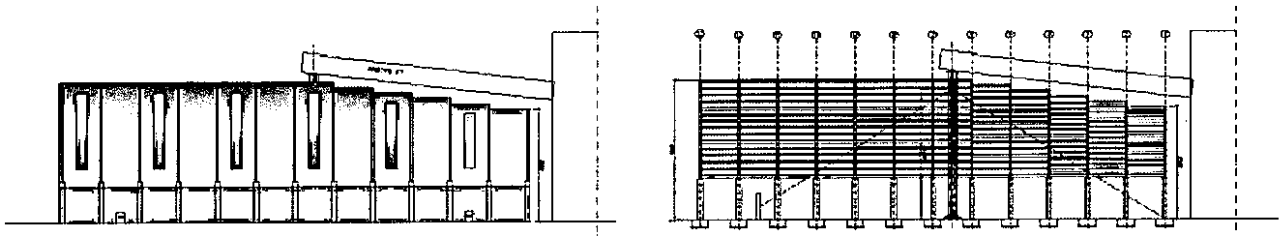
d Prospetto e sezione della copertura parco Sud
